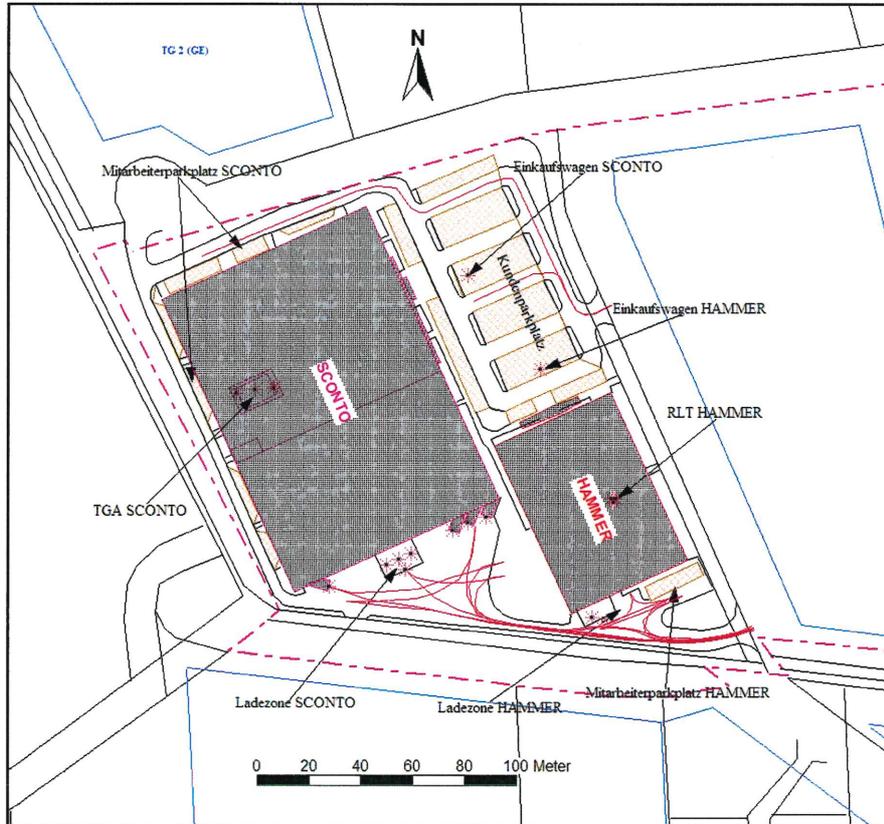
Lageplan zur 2018 geplanten Bebauungssituation im BP Nr. 100
